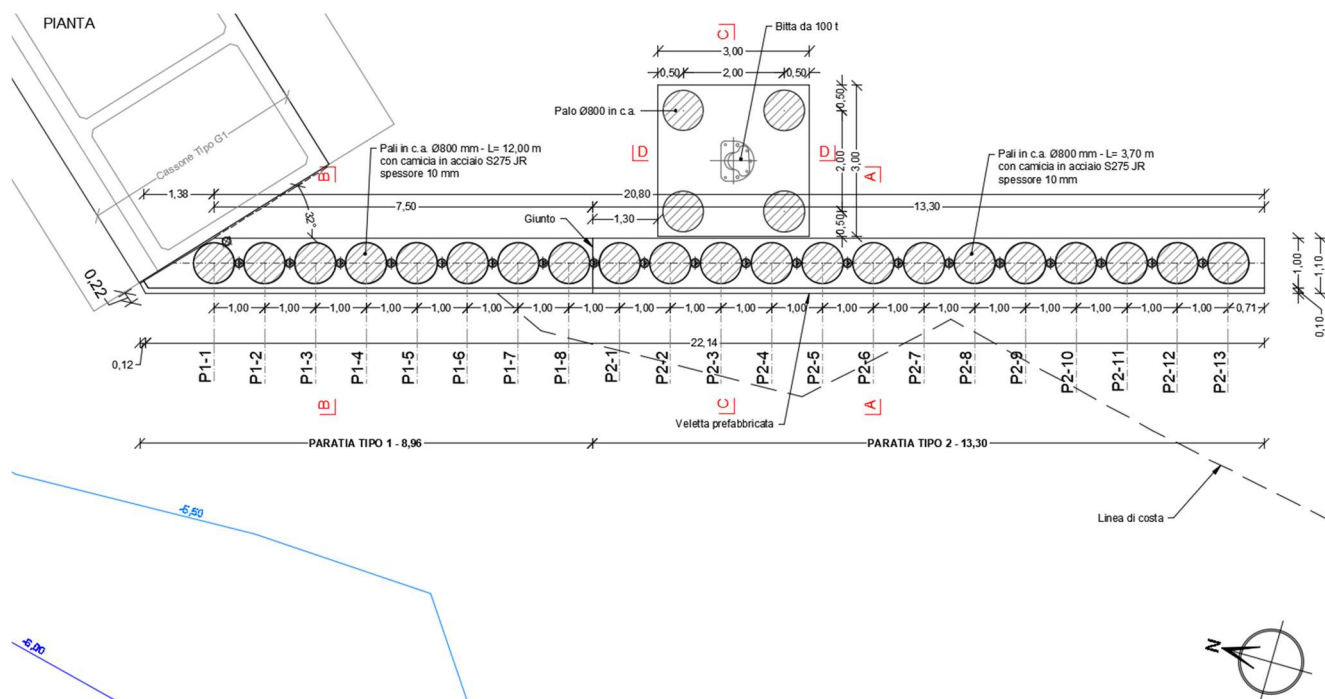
Paratia Tipo 1 e Tipo 2: planimetria
